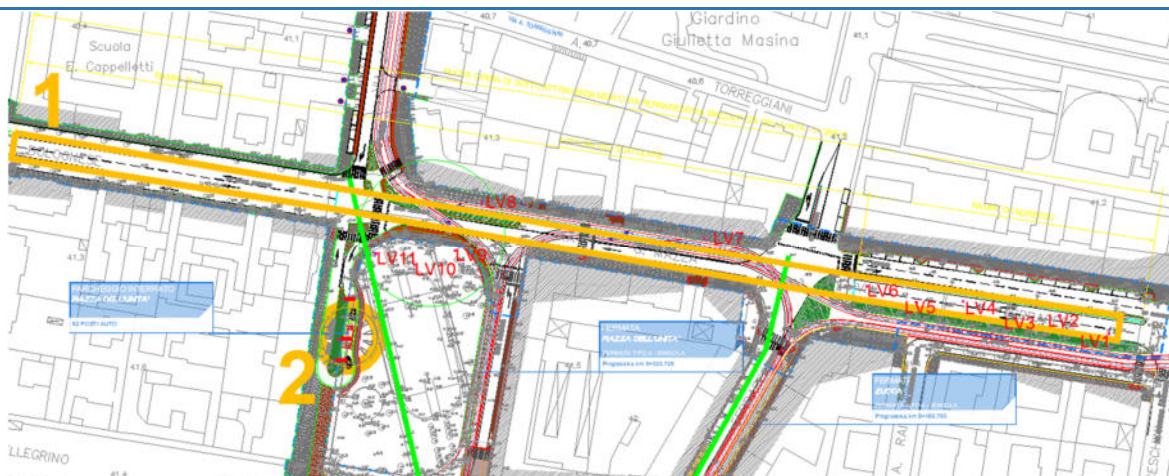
dettaglio del posizionamento dei carotaggi LV1 – LV11 sulla planimetria di progetto
